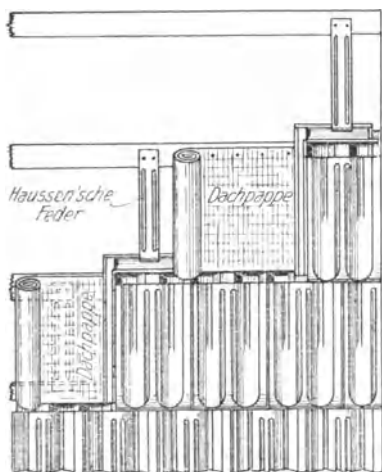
Die Unterdachkonstruktion „Patent Haussen“
